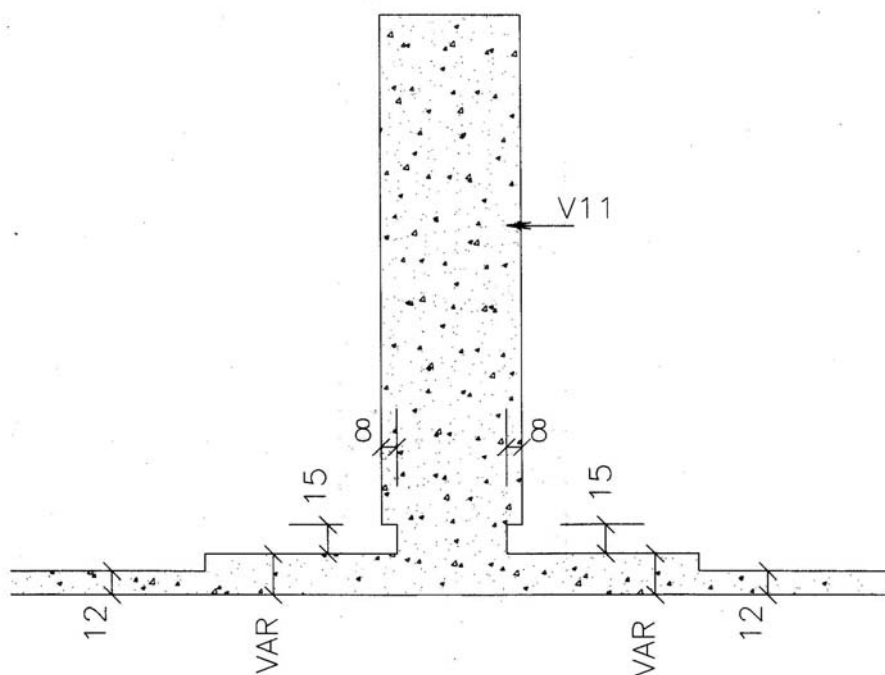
Fac-símile do projeto original da estrutura da cobertura do Mineirão, mostrando a demarcação das espessuras diferenciadas da laje
